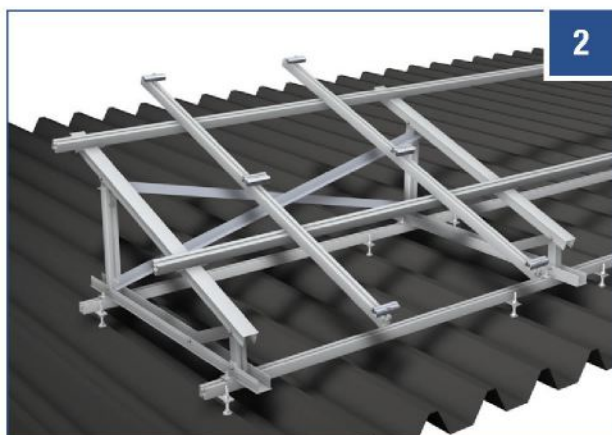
Para la colocación de módulos PV sin marco puede estar especificado un montaje en trabazón cruzada. Tenga en cuenta las indicaciones de montaje del fabricante de los módulos.
